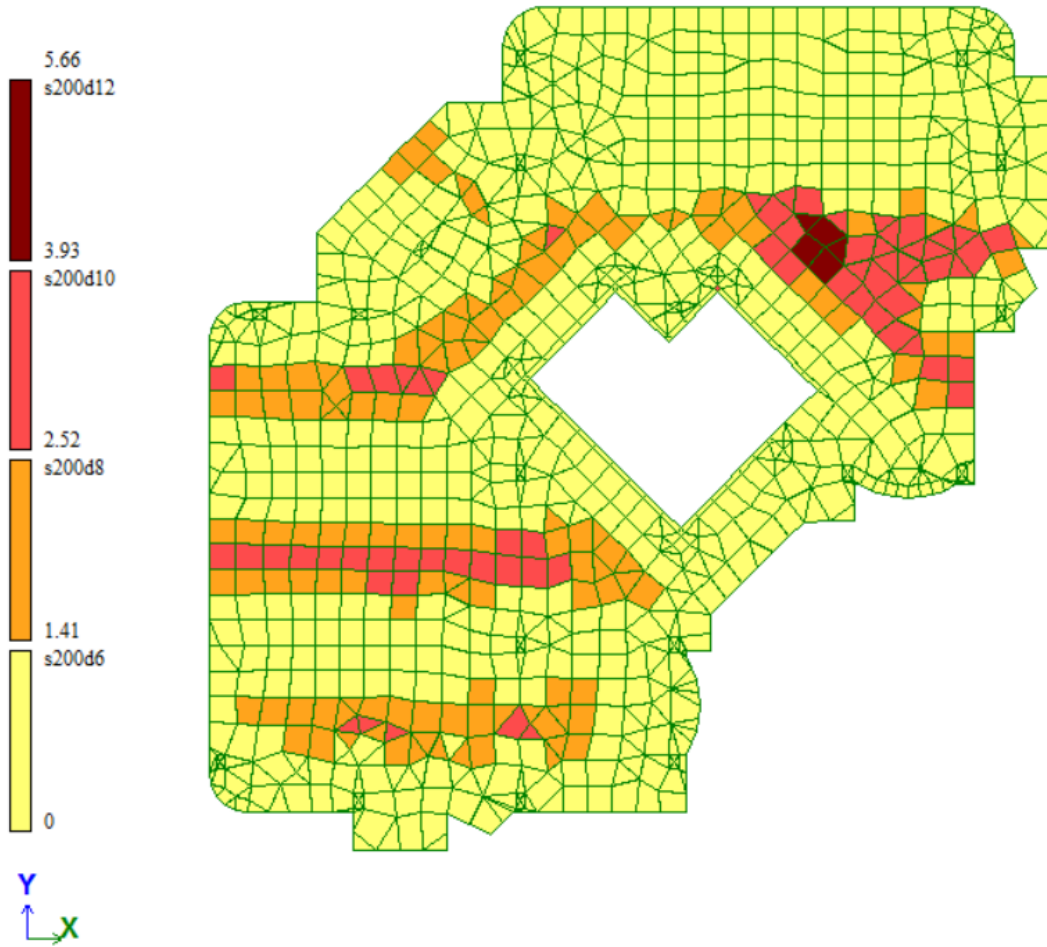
Нижняя грань, площадь арматуры вдоль оси Y
